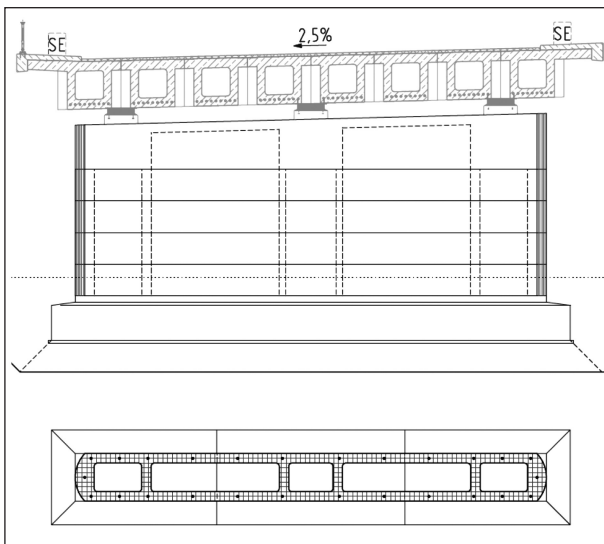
Stahlbetonhohlquerschnitt als Pfeilerscheibe
